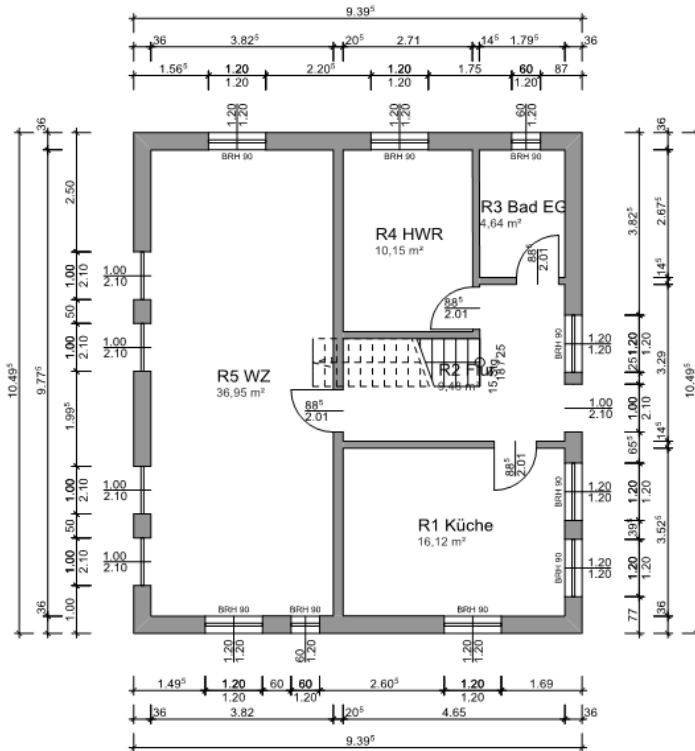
Grundriss EG Einfamilienhaus
